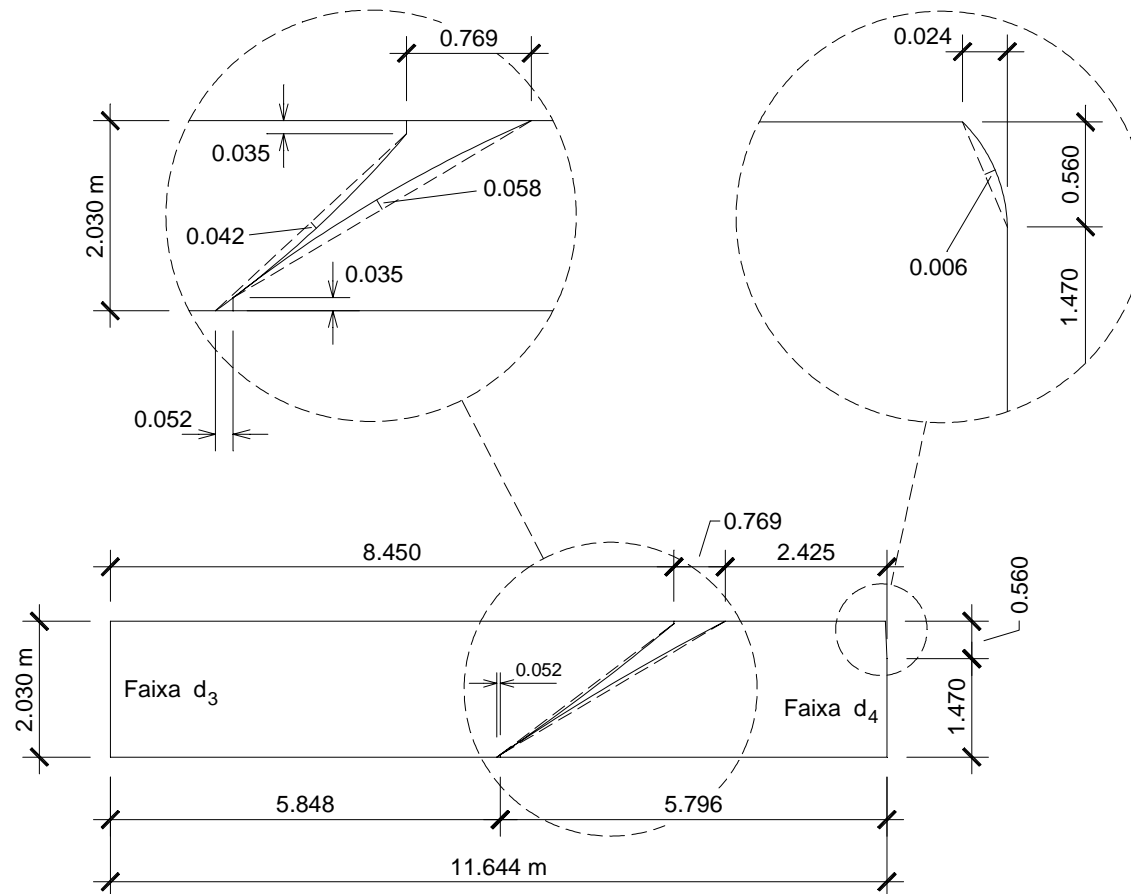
Detalhamento do corte das faixas  $b_2$  do Painel 1 ("corpo").
